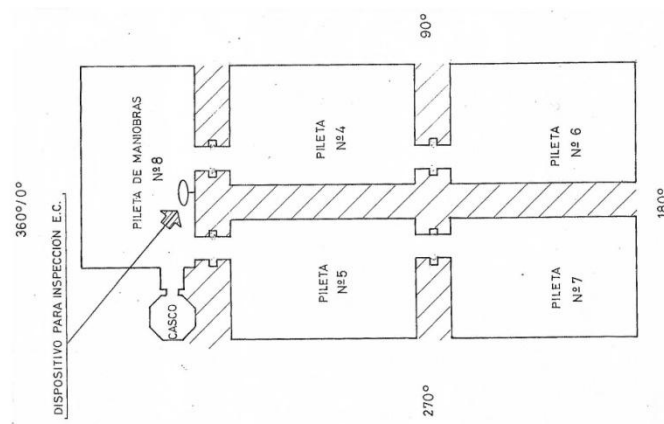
Plano de ubicación del periscopio de casa de piletas 2.
